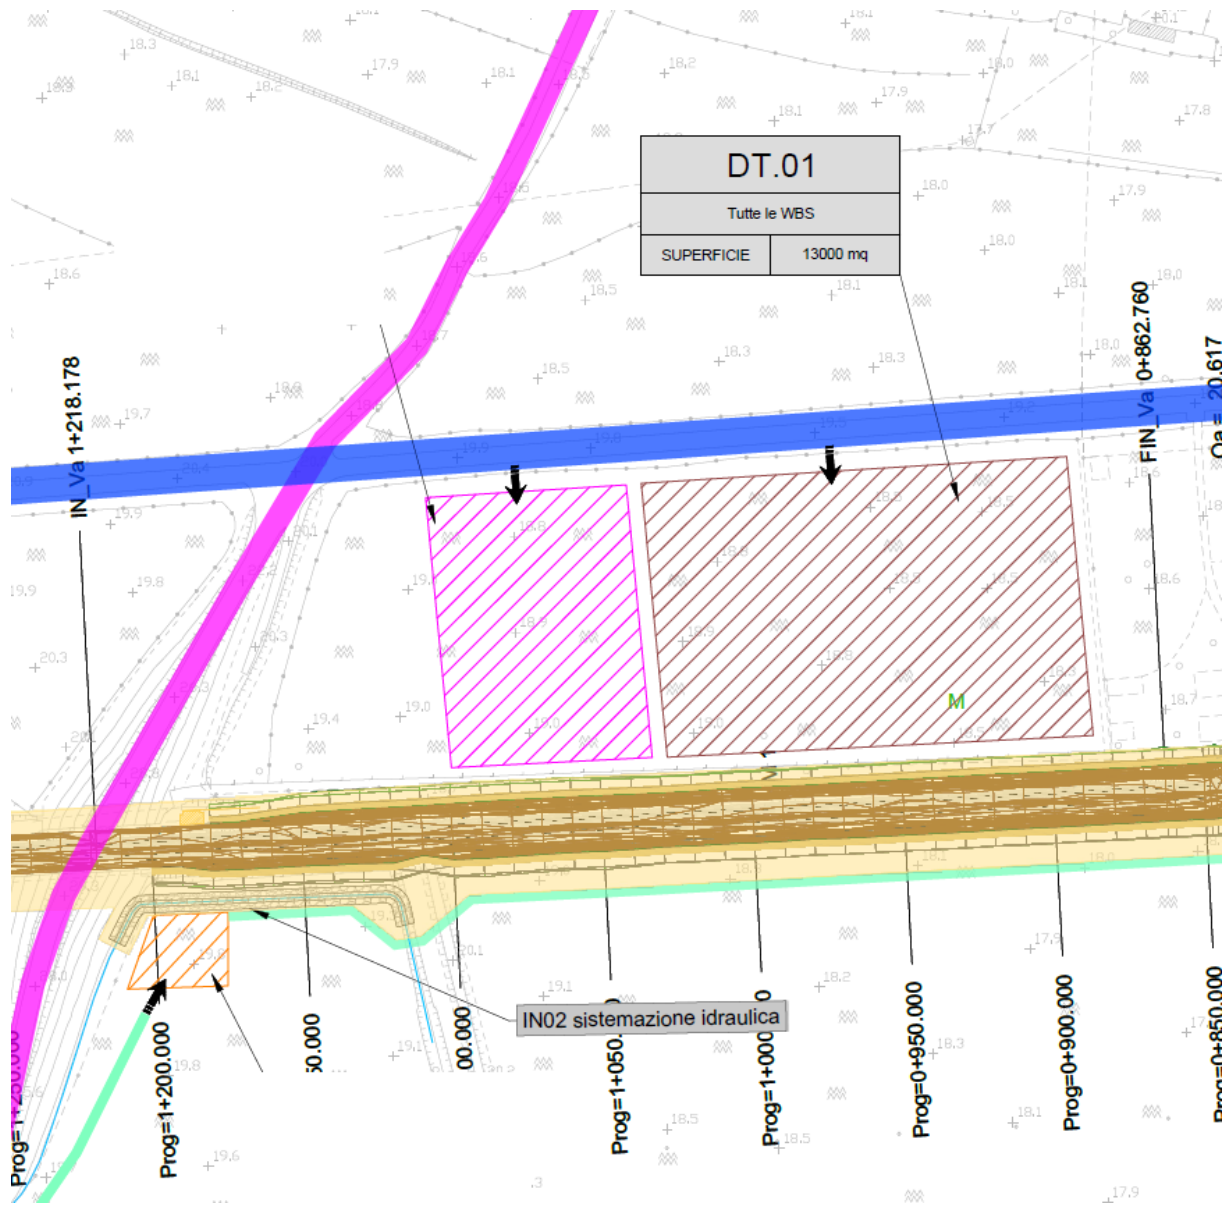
Vista in pianta dell'area di cantiere DT.01
